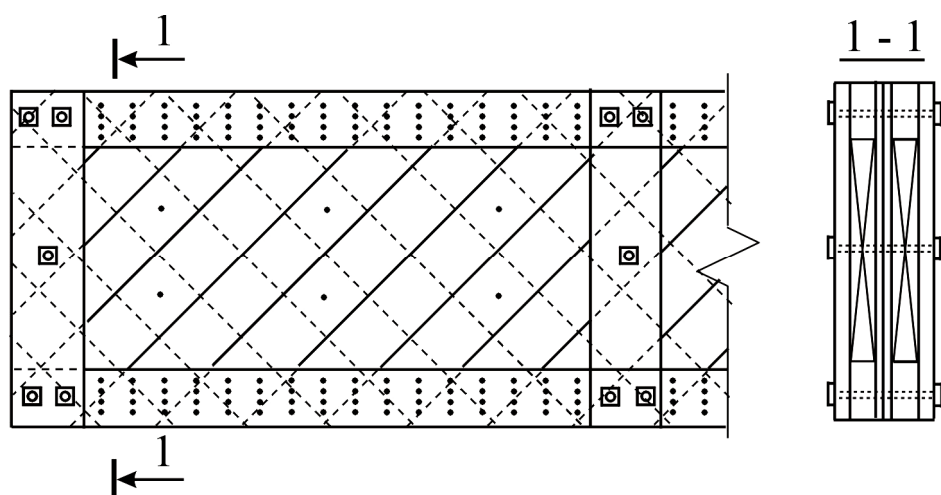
Дощато-гвоздевая балка с перекрестной дощатой стенкой
